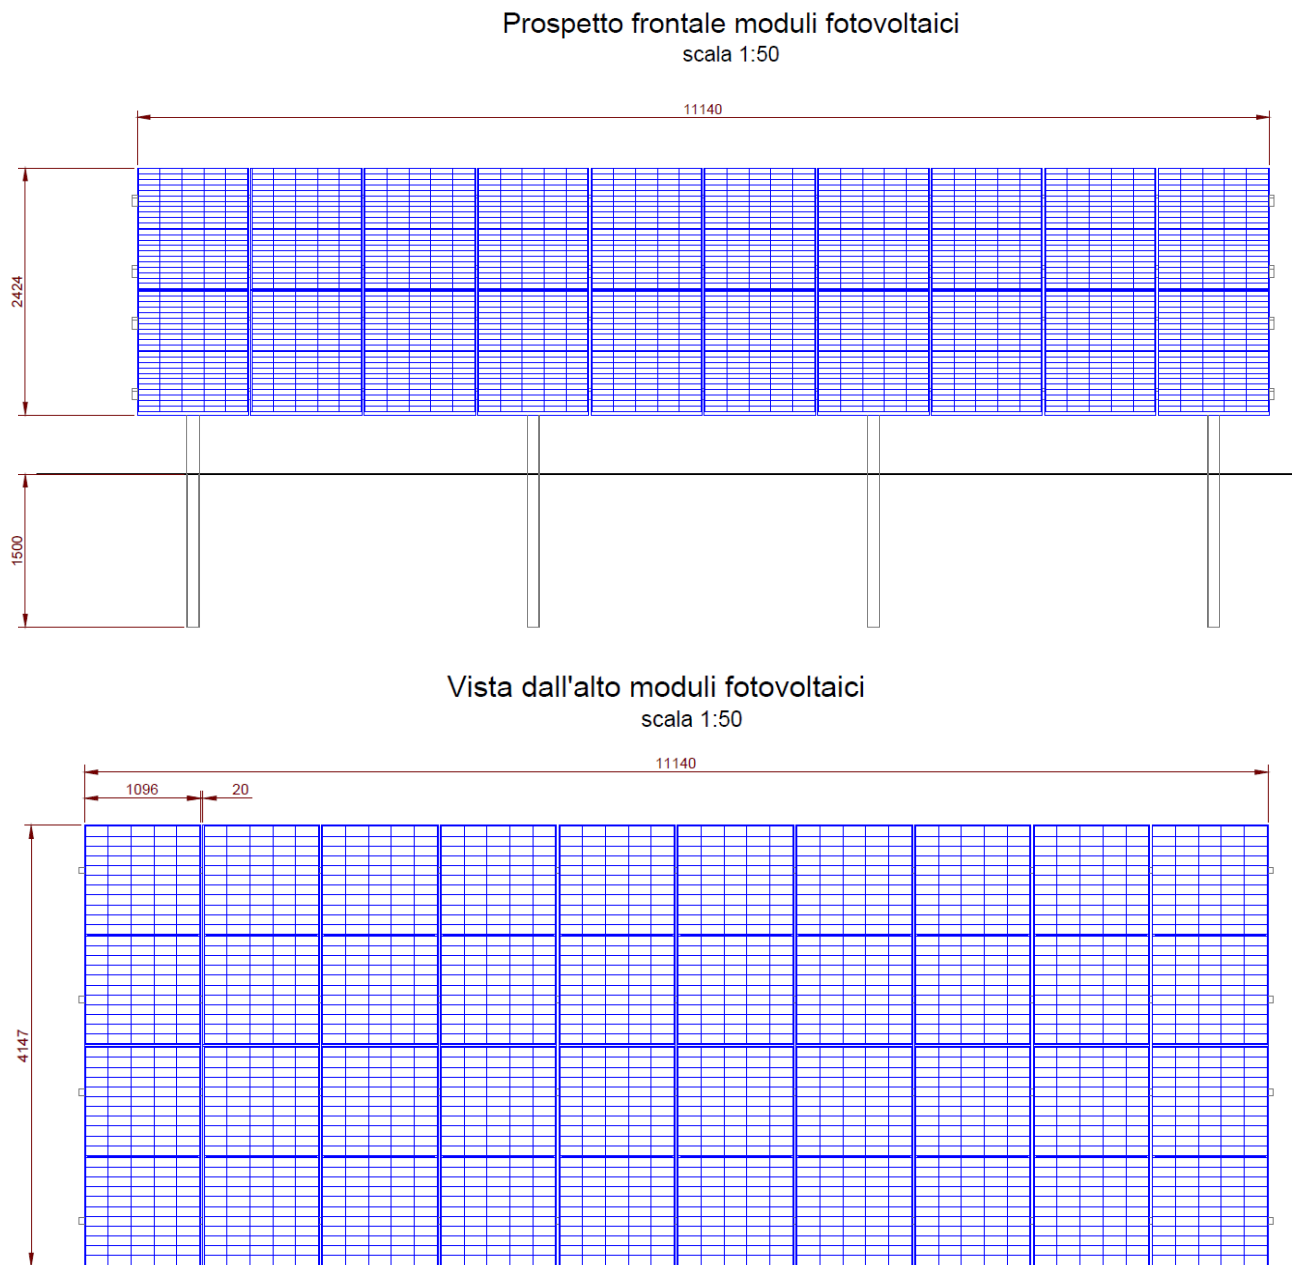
prospetto frontale e vista dall'alto delle strutture
